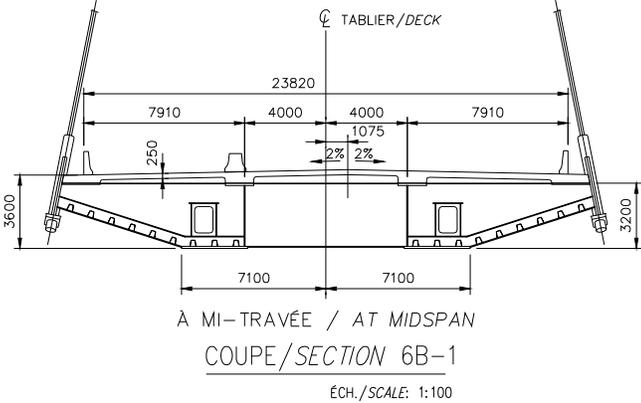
Coupe transversale – Pont à haubans – Solution caisson fermé
